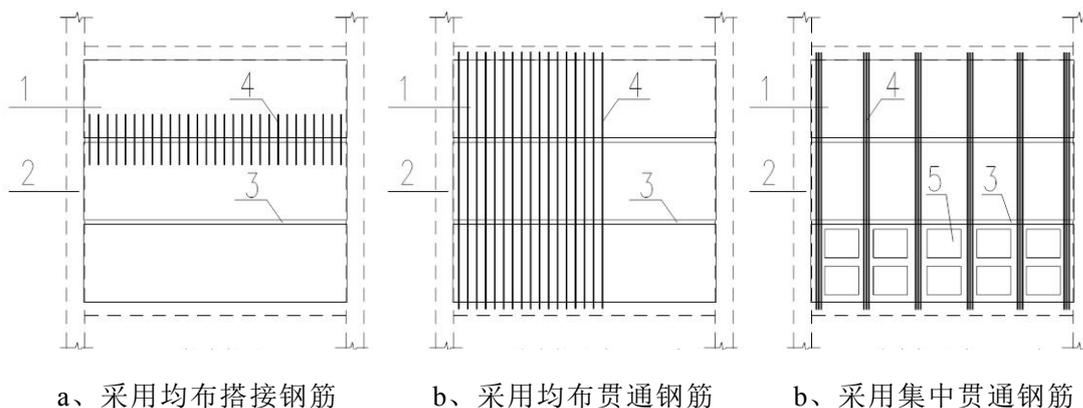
叠合板的预制底板密拼式整体拼缝连接钢筋布置示意图
